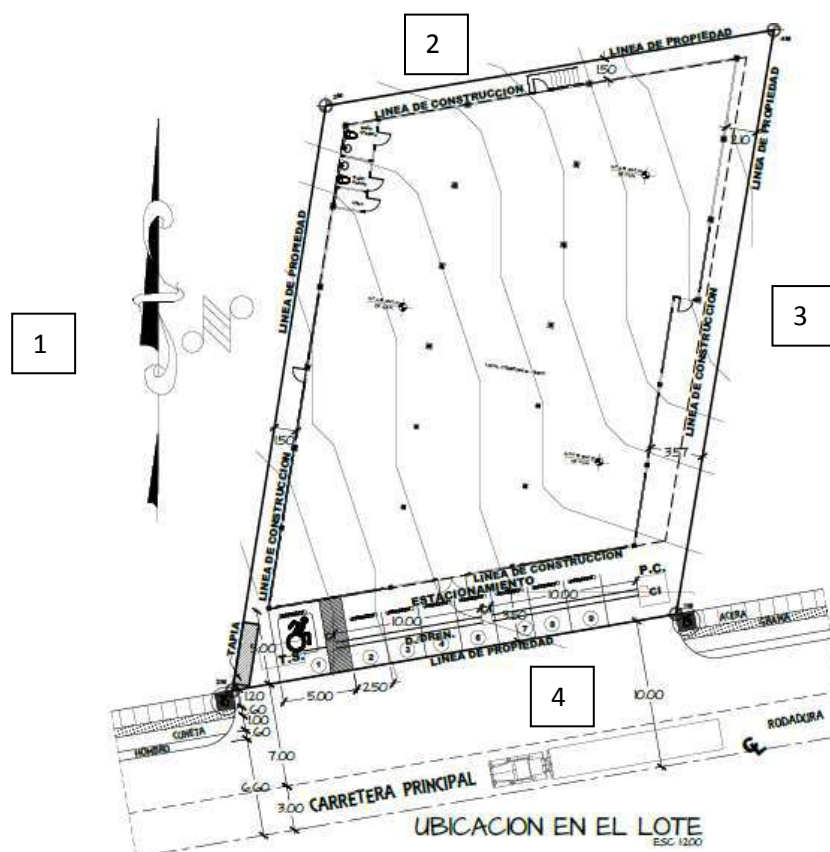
Terreno donde se desarrollará el proyecto Fuente. Equipo consultor
